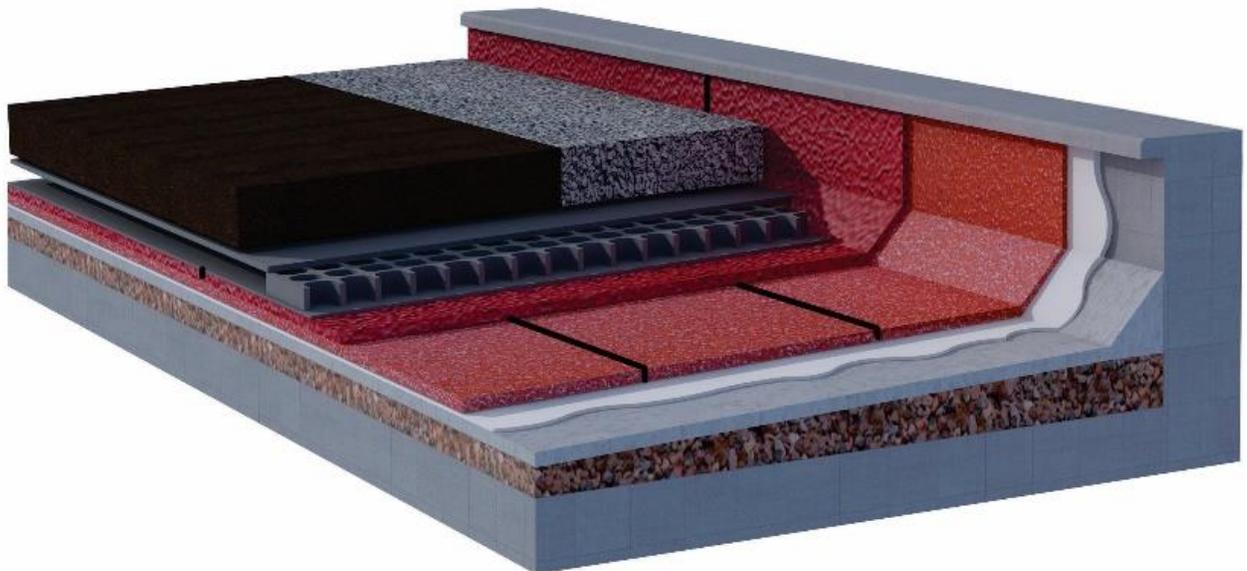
Pretil perimetral con cabezal descubierto y pendiente sobre soporte base
